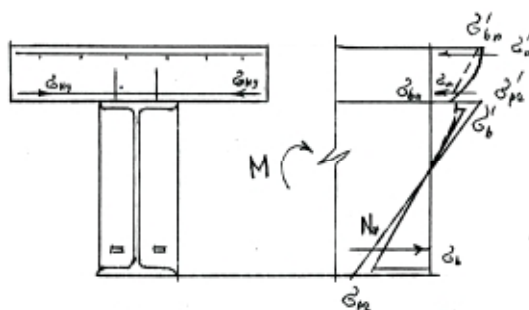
Схема усилий и напряжений в расчетном сечении перекрытия
